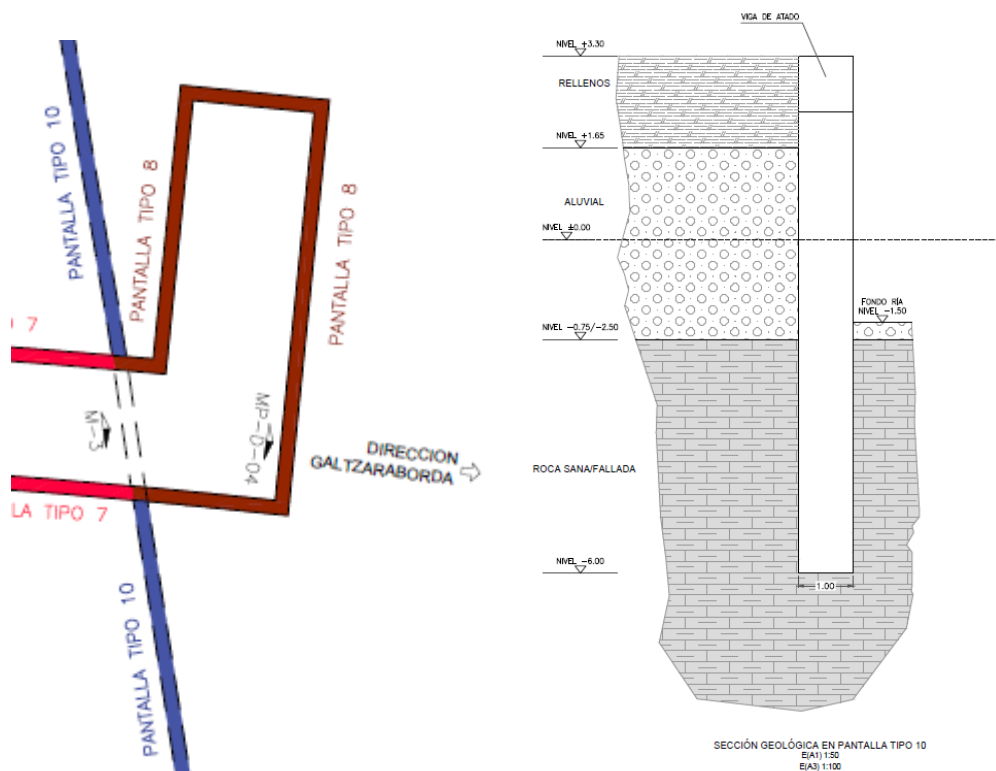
Sección pantalla tipo 10 como muro en M1
